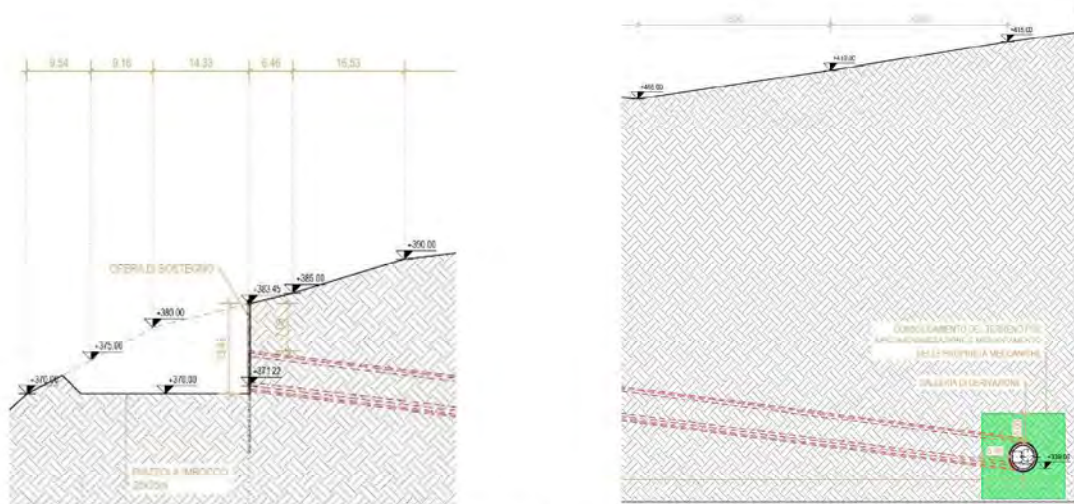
Profilo terreno. Sezione lungo la galleria laterale (Discenderia).
